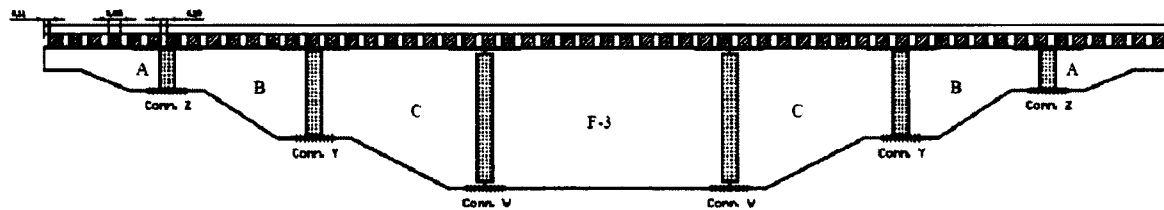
Pont bi-poutres - Agencement pour une portée de 23m
